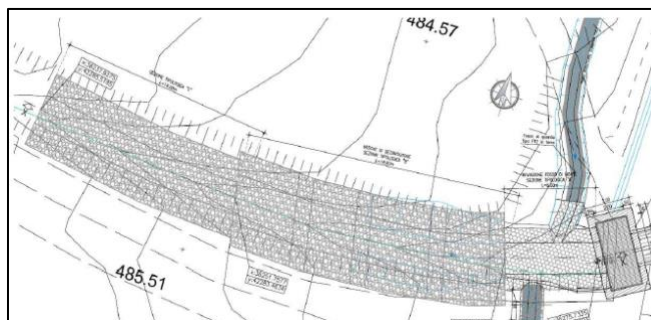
Stralcio planimetrico inalveazione a monte del TS57
